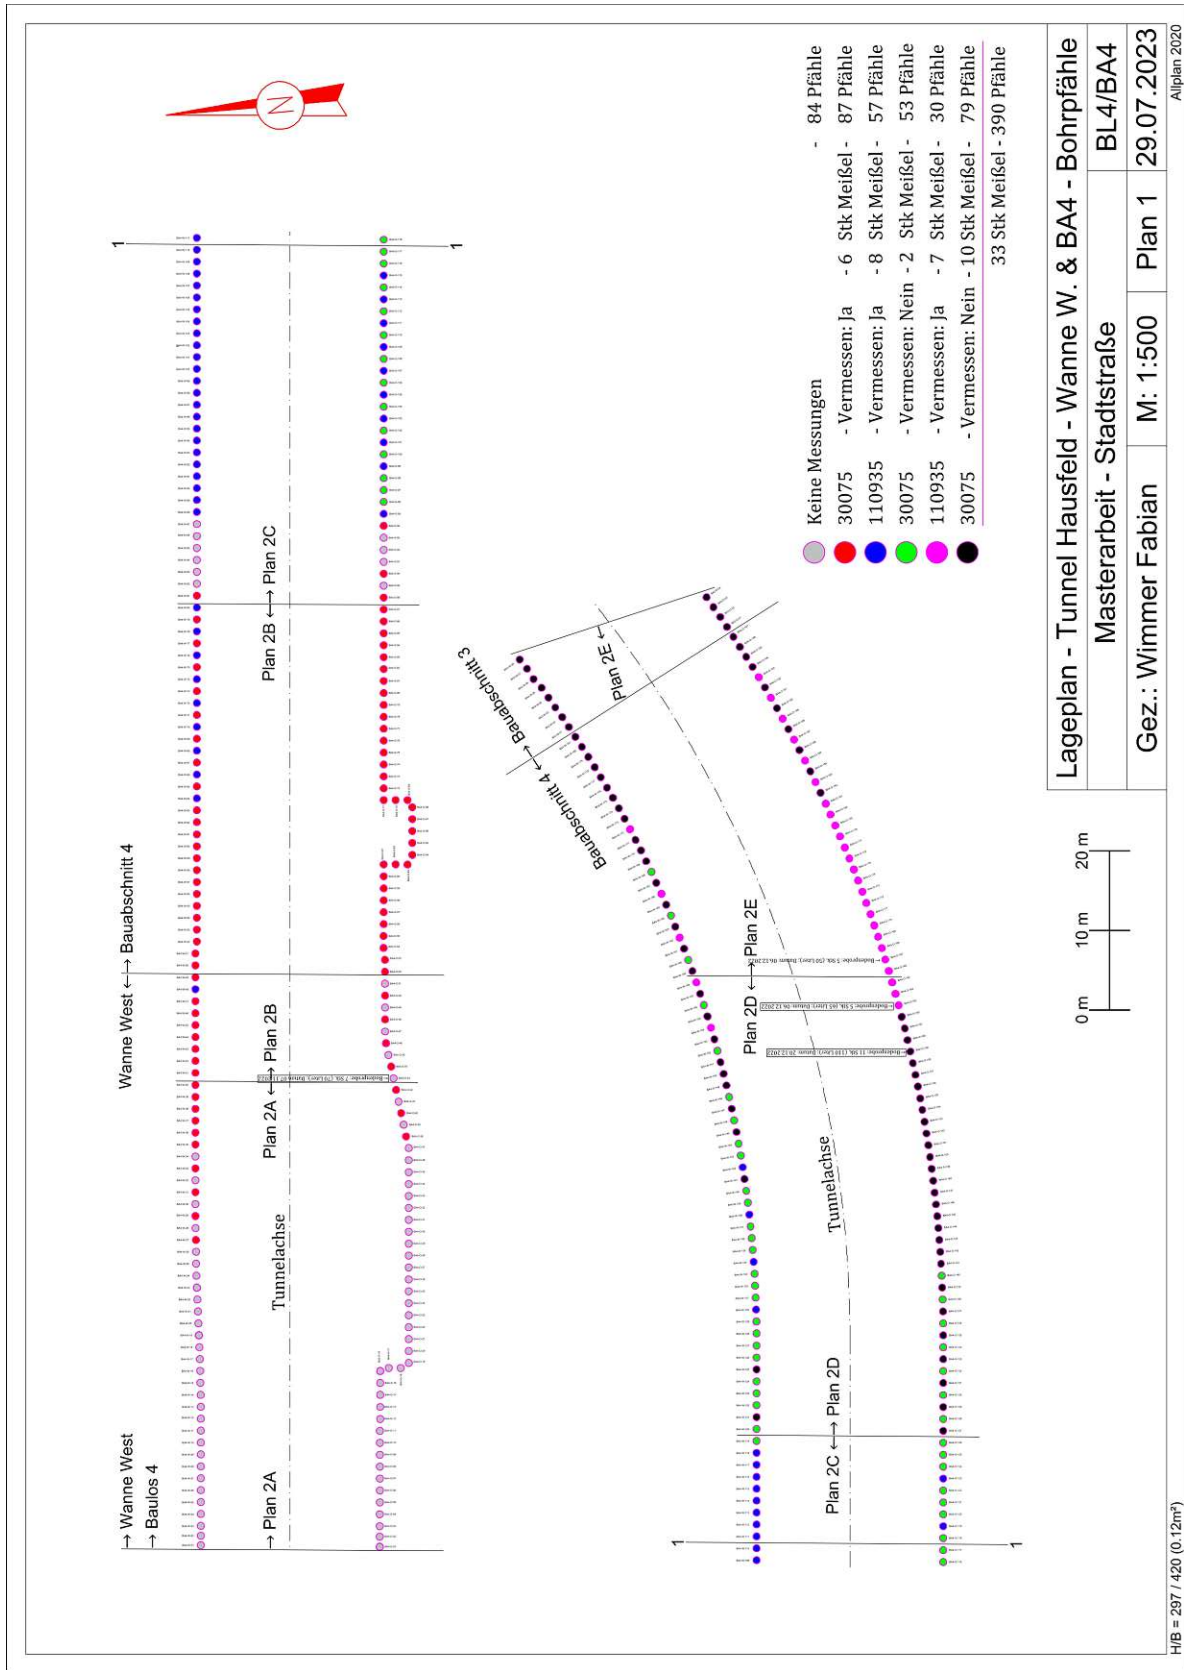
Lageplan - Tunnel Hausfeld, Wanne West und BA4 - Gesamtübersicht Plan 1; Plangrundlage [15]
